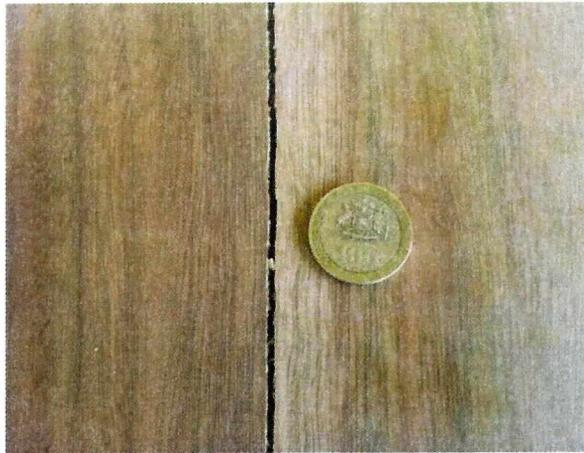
Detalle de fisura en muro oriente de la sala de clases A2, del primer piso del módulo A.
